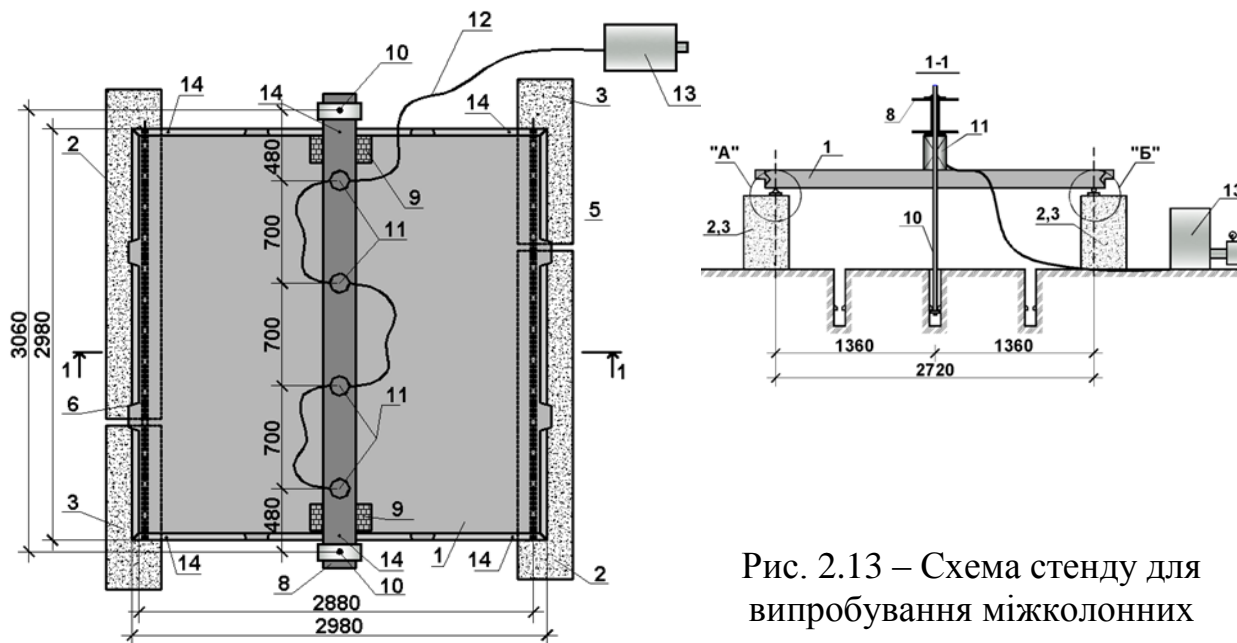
Схема стану для випробування міжколонних плит:
